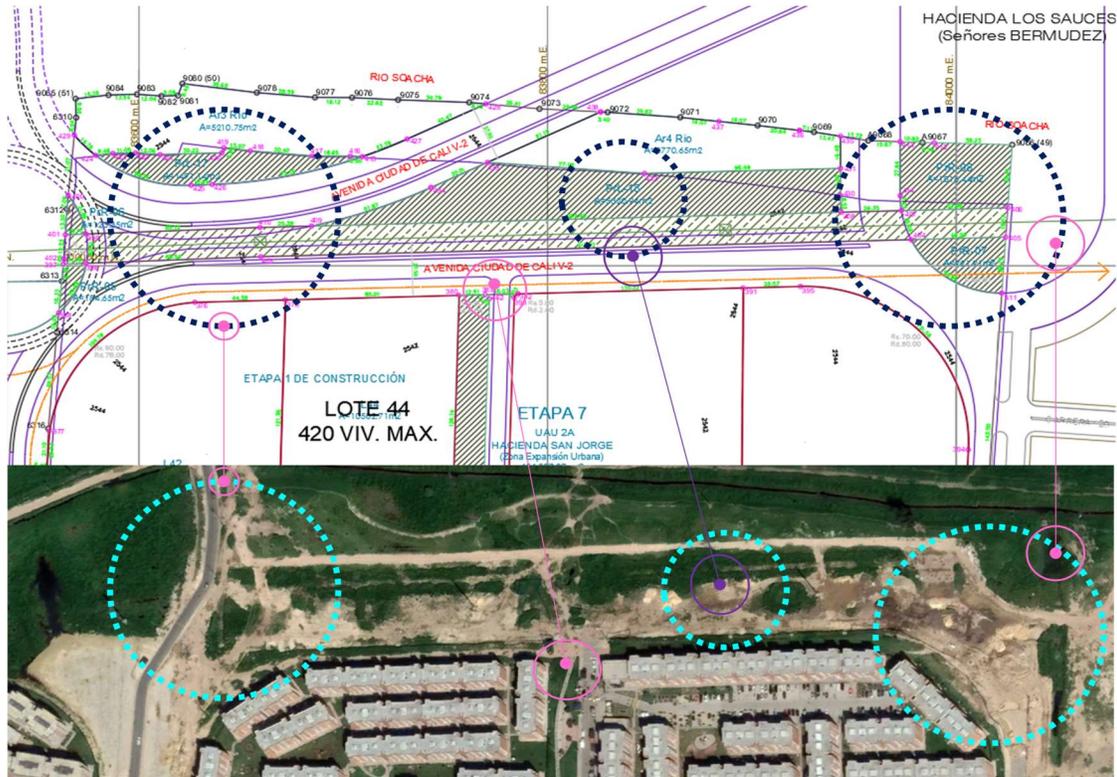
Diferencia entre planimetría y desarrollo zonas verdes y parques recreativos costado norte PP Las Huertas, Franja Av. Ciudad de Cali. Comparativo entre Planimetría Proyecto urbanístico Hogares Soacha e Imagen Satelital diciembre 2020.
